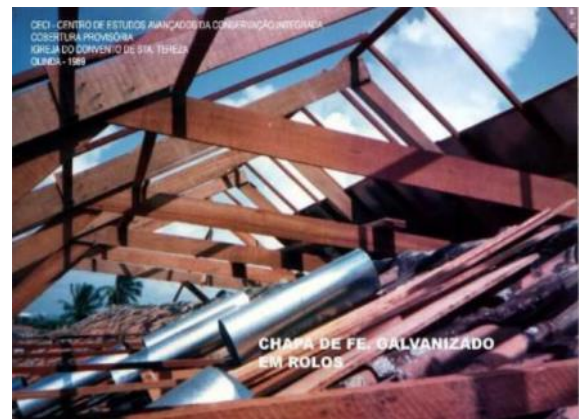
Vista das tesouras armadas e das chapas de ferro galvanizado em rolos
